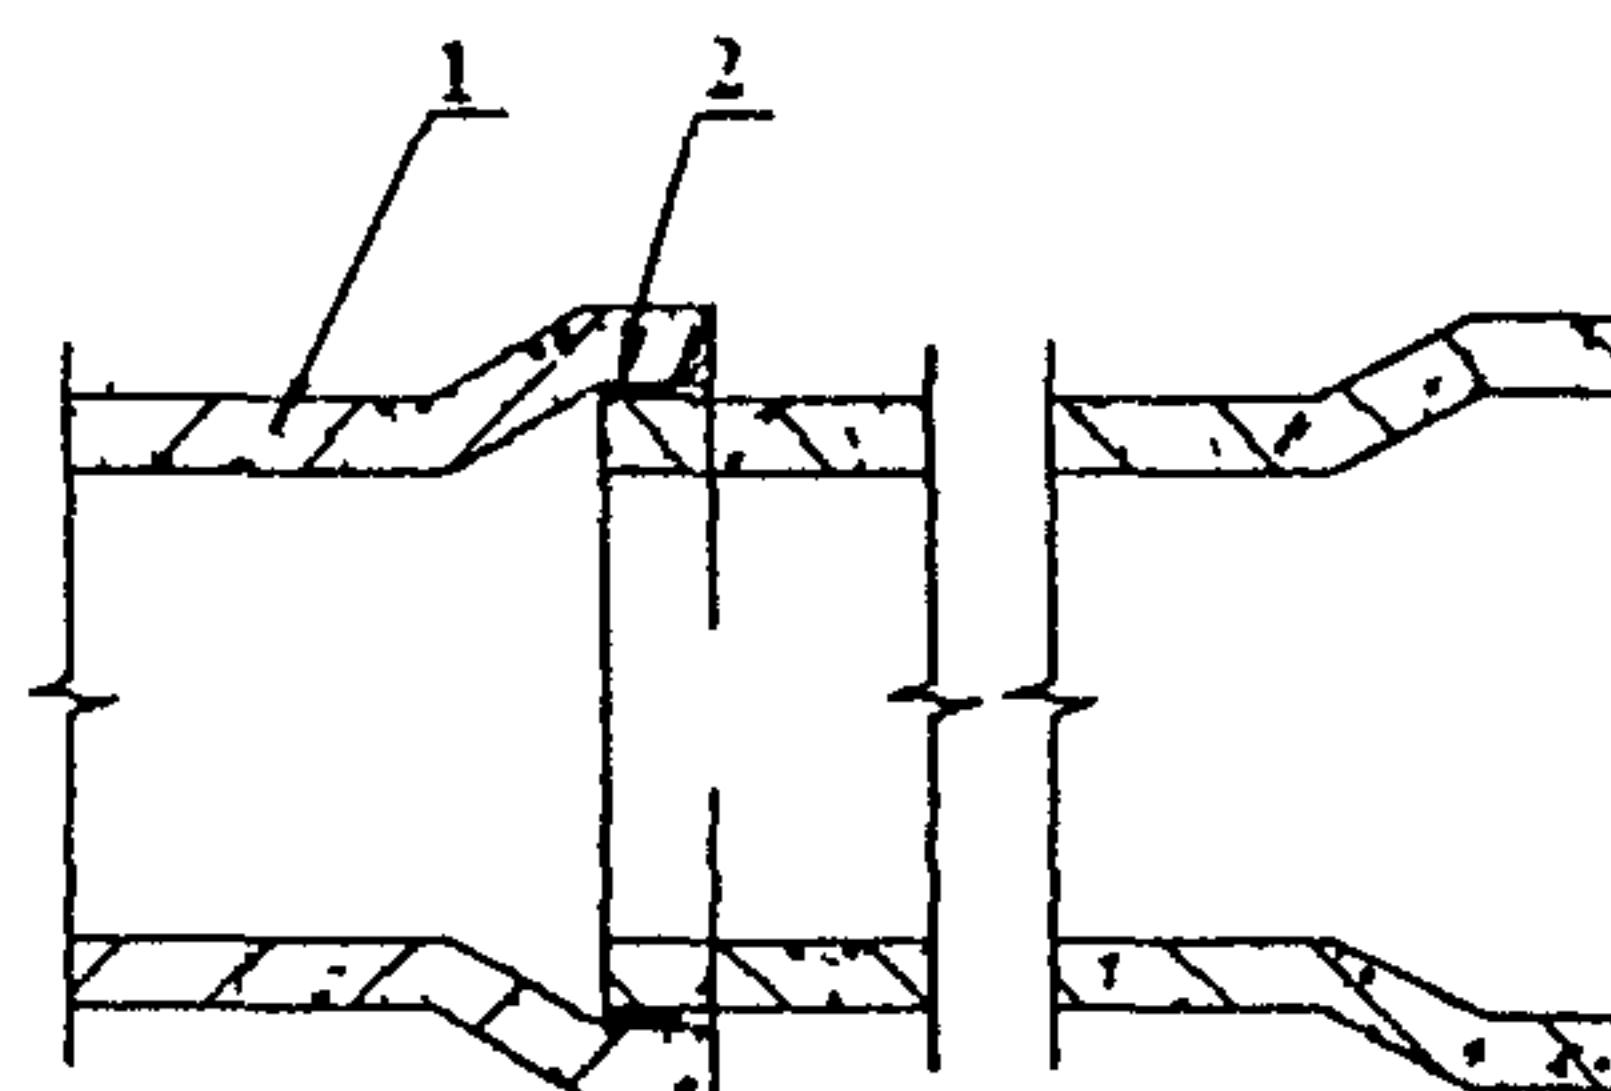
Герметизация стыков железобетонных труб путем последовательной промазки их герметиком ТФ-1-ВА:
